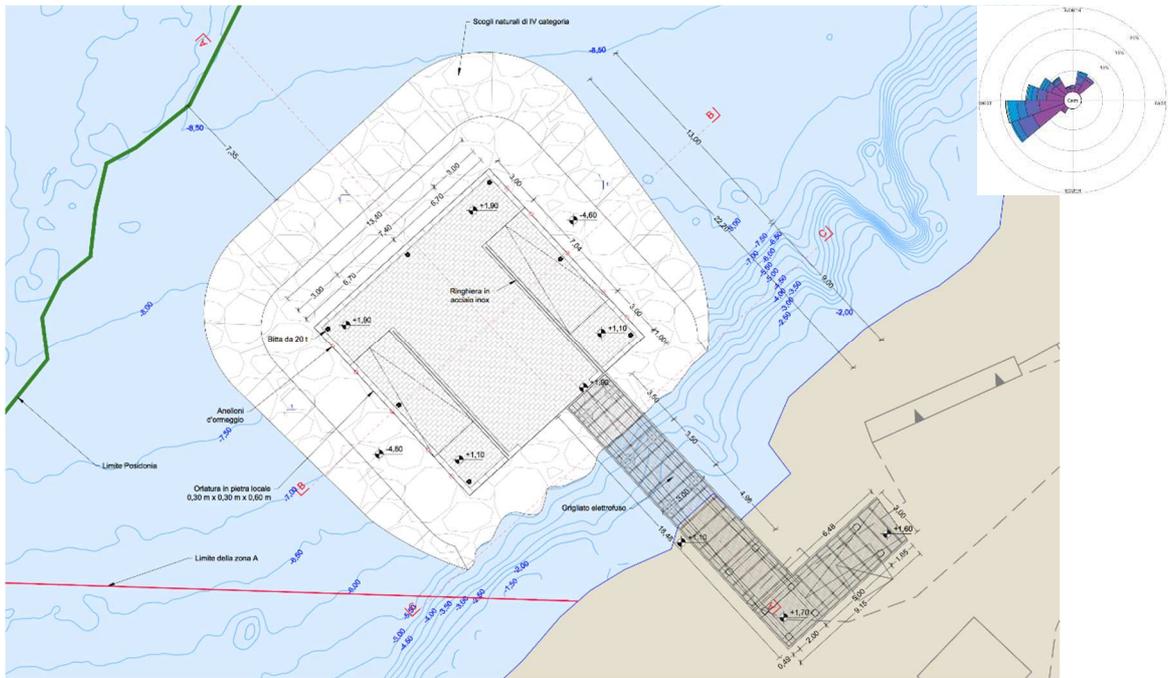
Soluzione finale (Alternativa 5). Pianta
